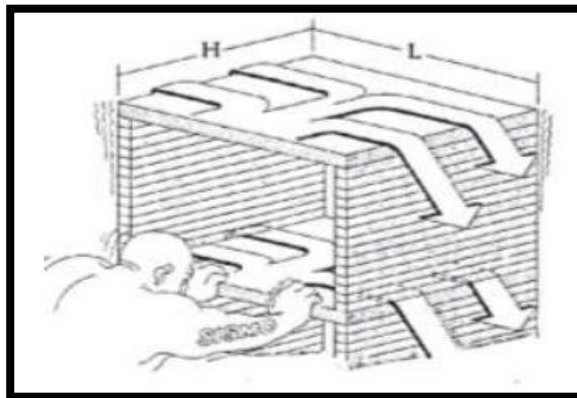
Se observa la acción de una fuerza lateral aplicado a la estructura, generando así deformaciones en los elementos estructurales.
